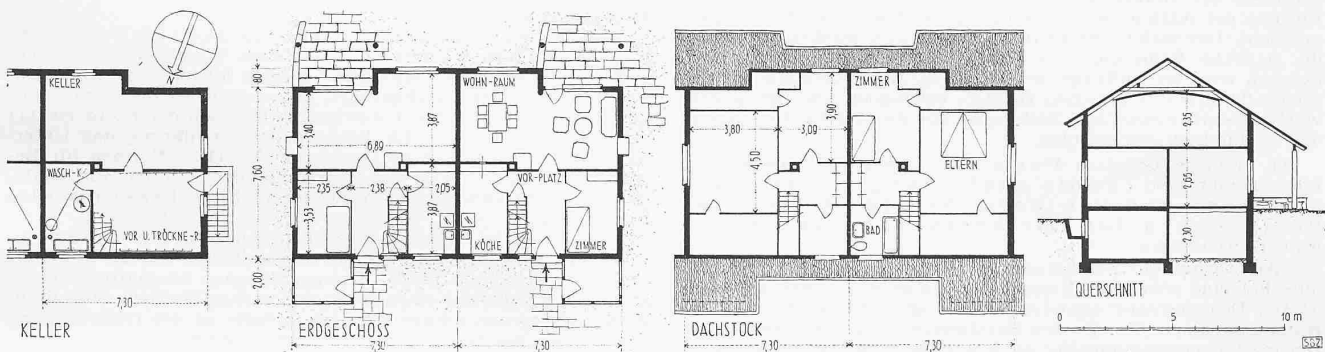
bis 13. Siedlung «Im Wiesental», Kilchberg. Arch. ALFRED BINGGELI, Zürich-Kilchberg. — Grundrisse und Schnitt 1 : 300, Haustyp B
